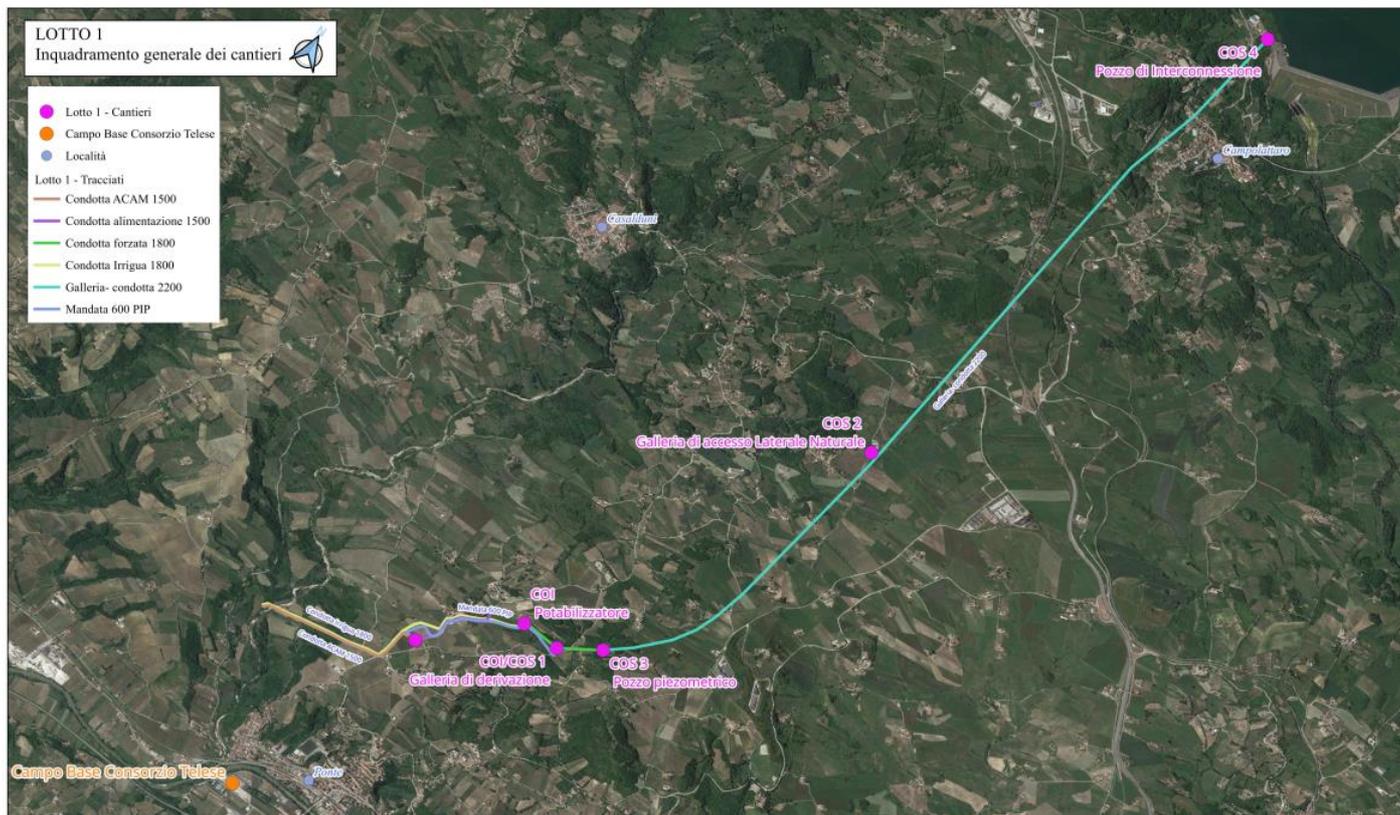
Individuazione dei cantieri di progetto del Lotto 1
